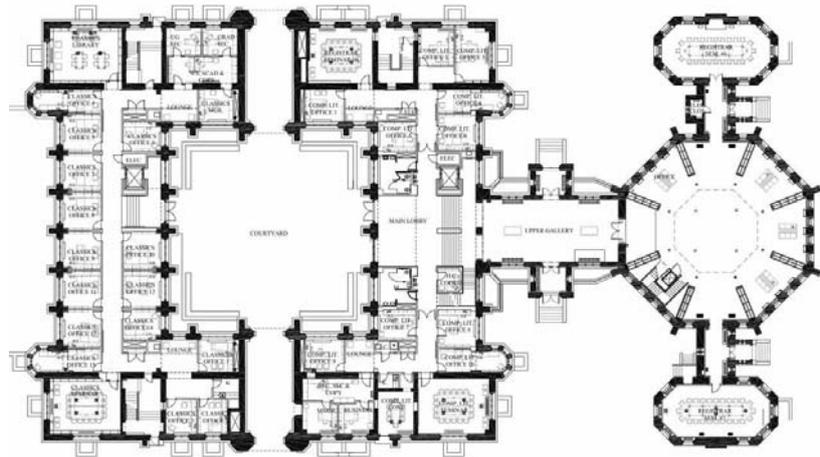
24: Pyne Grundriss Erdgeschoss
